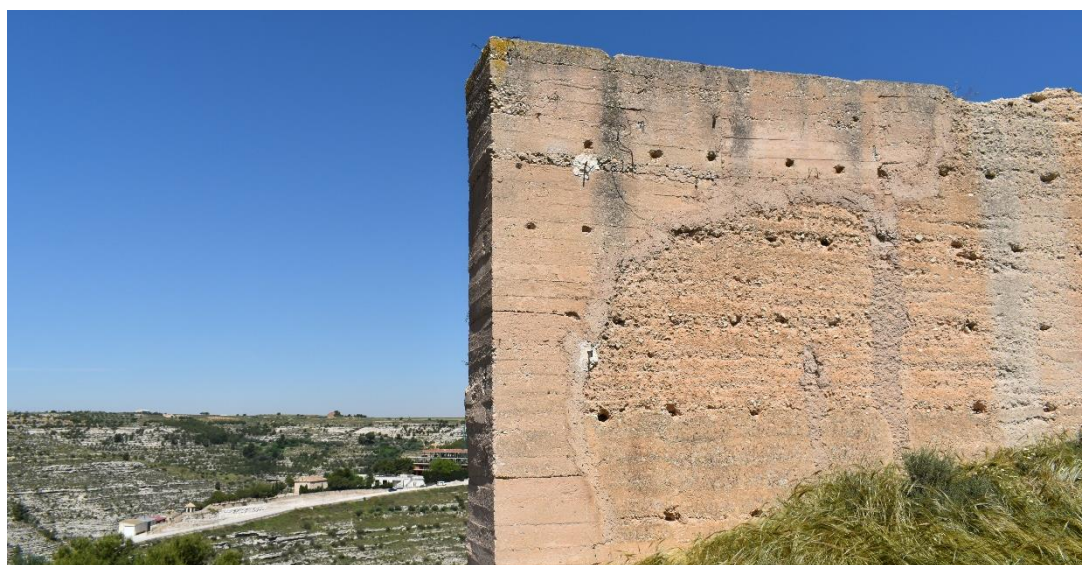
Detalle 2.5. Remate consolidado lienzo 6 con hormigón de cal, piedra y arena parda., espesor de 1,15 m. Fuente: Autora.
